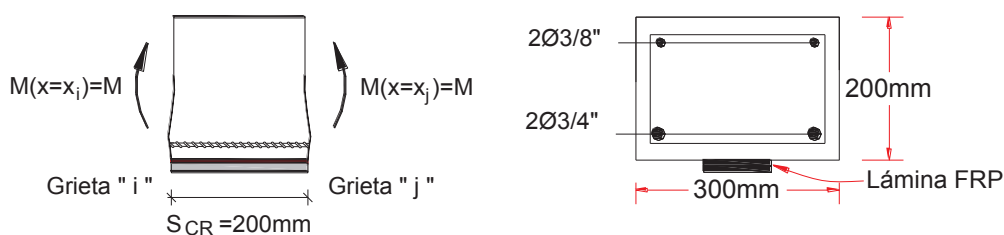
Elemento de viga entre dos grietas sujeto a flexión pura
